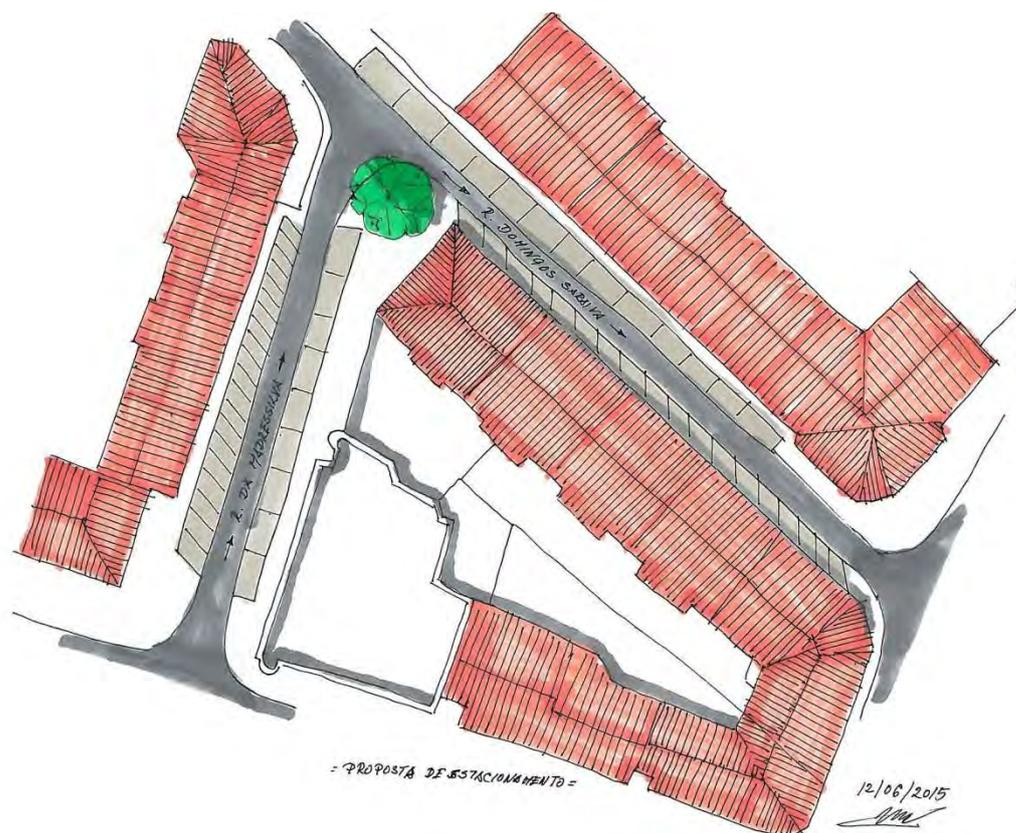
Planta de intenção de desenho urbano alternativo para o estacionamento nas Ruas Domingos Saraiva e Madressilva
